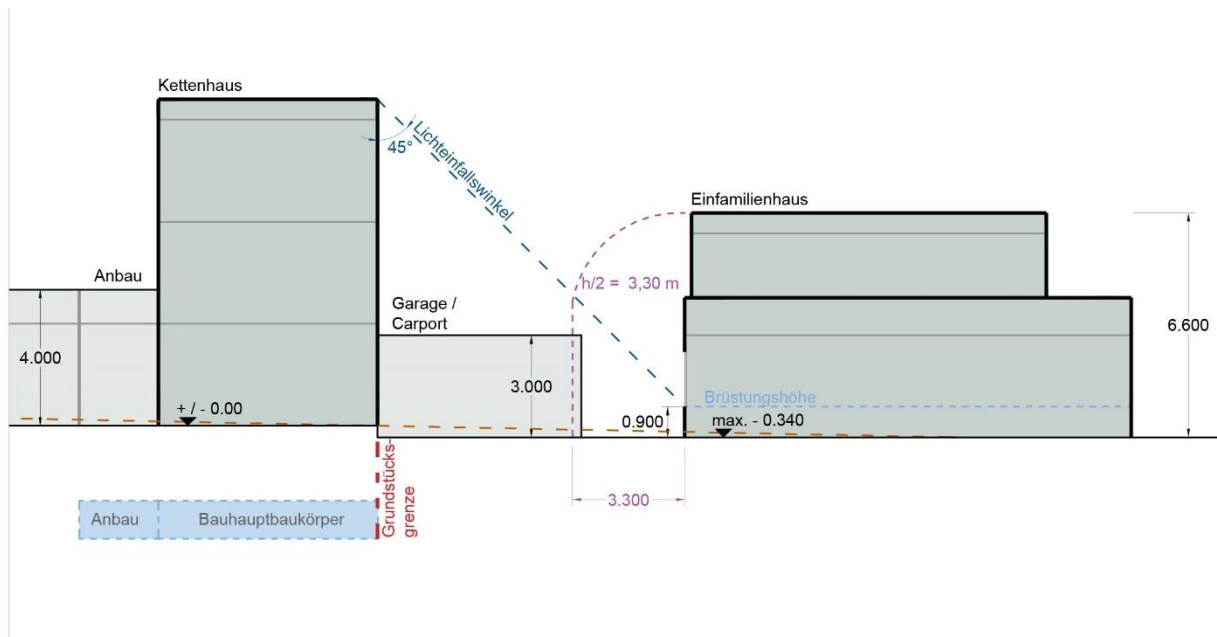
Schnittansicht Kettenhaus/ Einfamilienhaus – Garage/ Carport mit Grenzanbau zum Kettenhaus, o. M.
